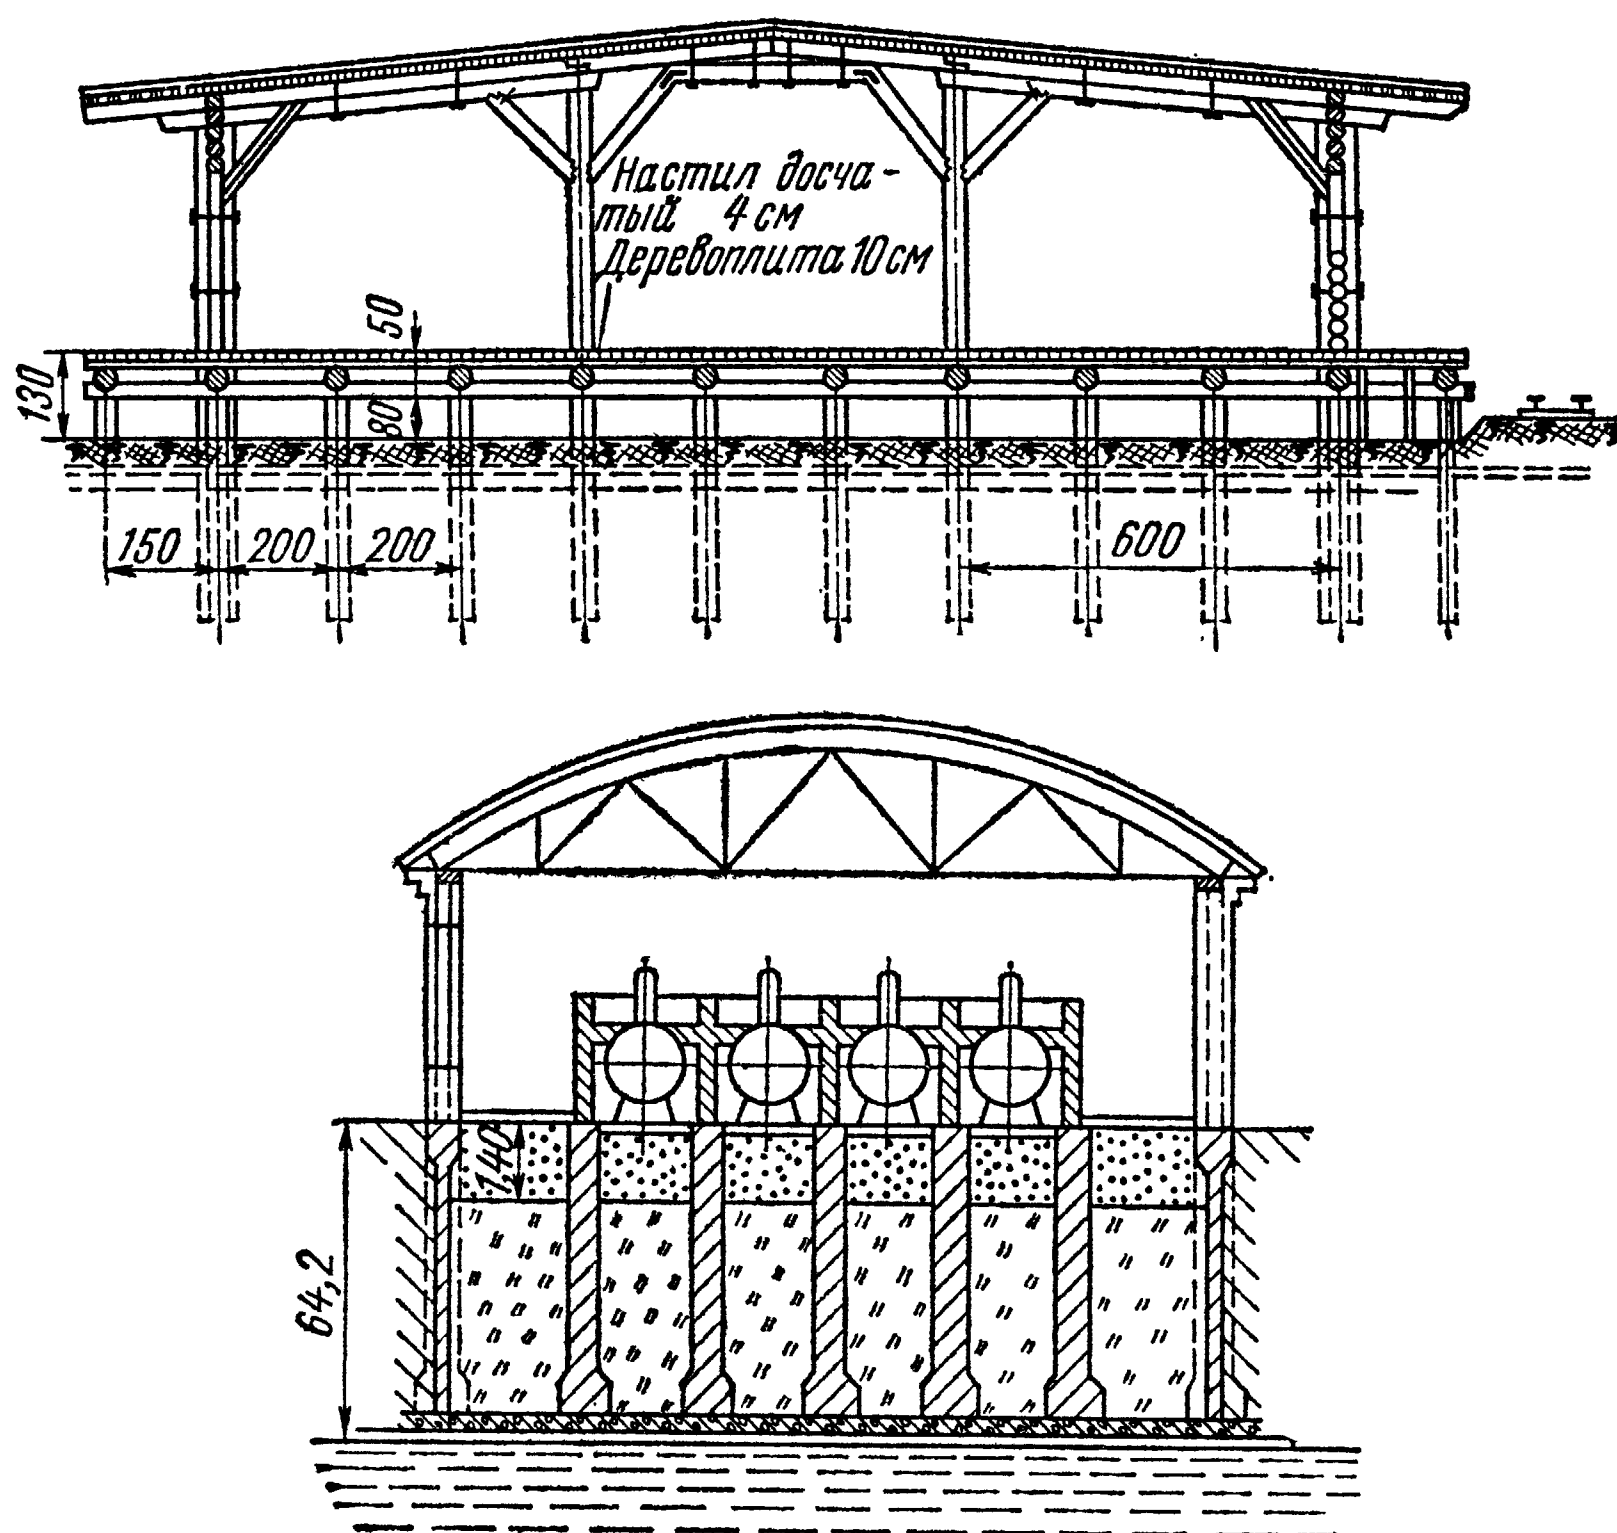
Столбчатые фундаменты на вечномёрзлых грунтах
